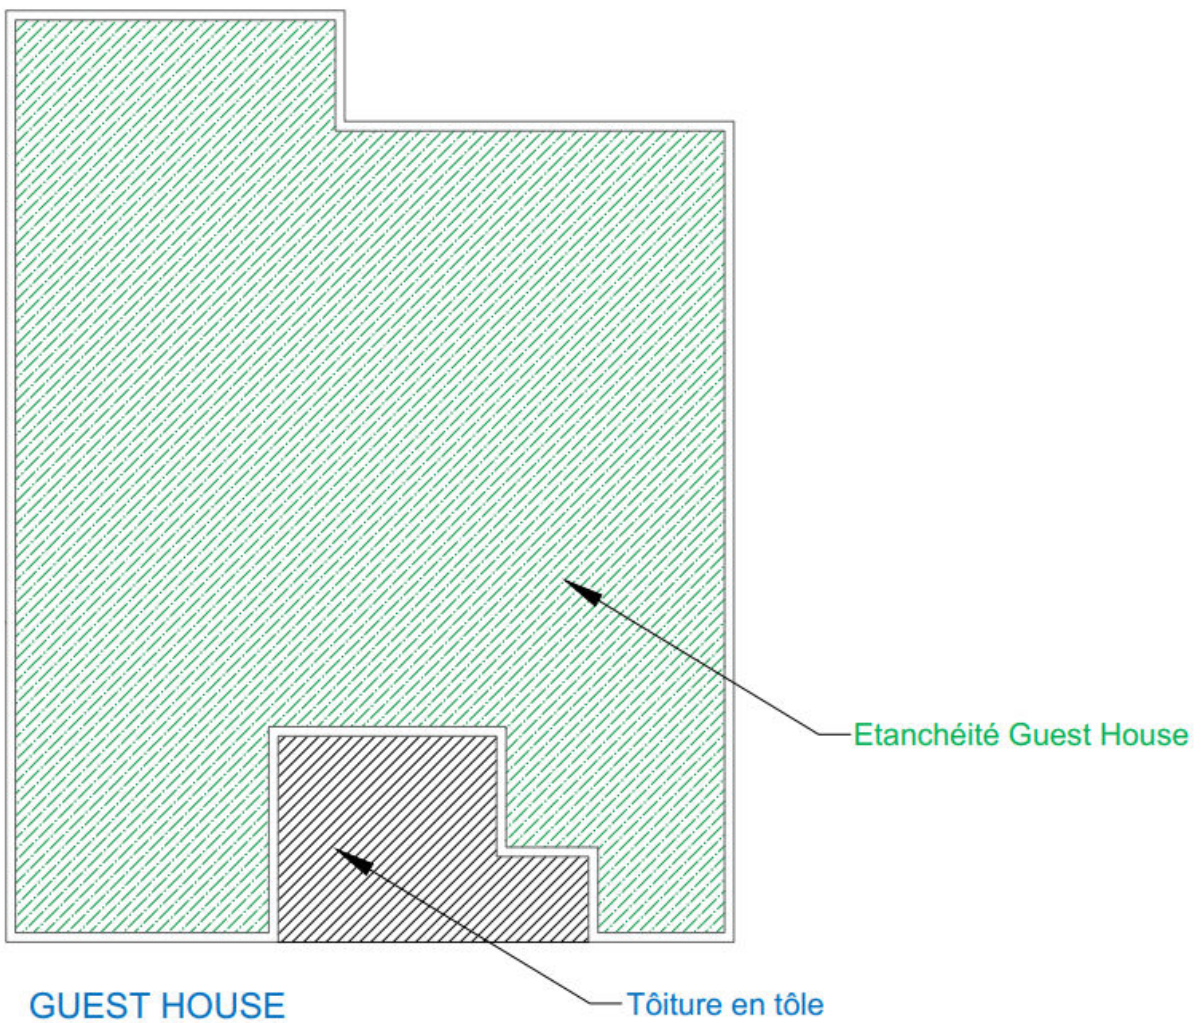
Surface de l'étanchéité sur la toiture de la Guest House
